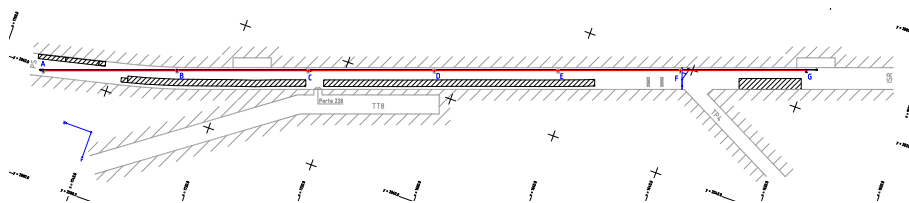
Plan de masse du test d'alignement du TT1
